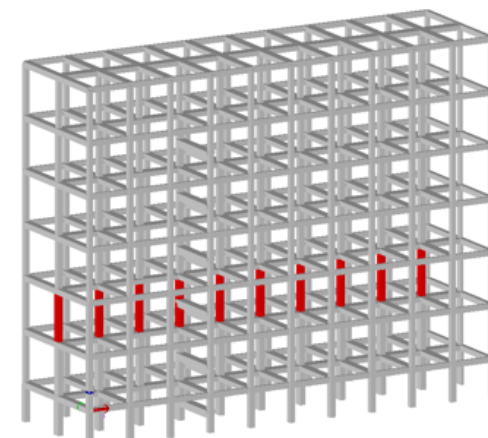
Modello US B1 - PROSAP, Archivio Sezioni, Proprietà n° 3: Pilastro 50 x 60, con inquadramento.
